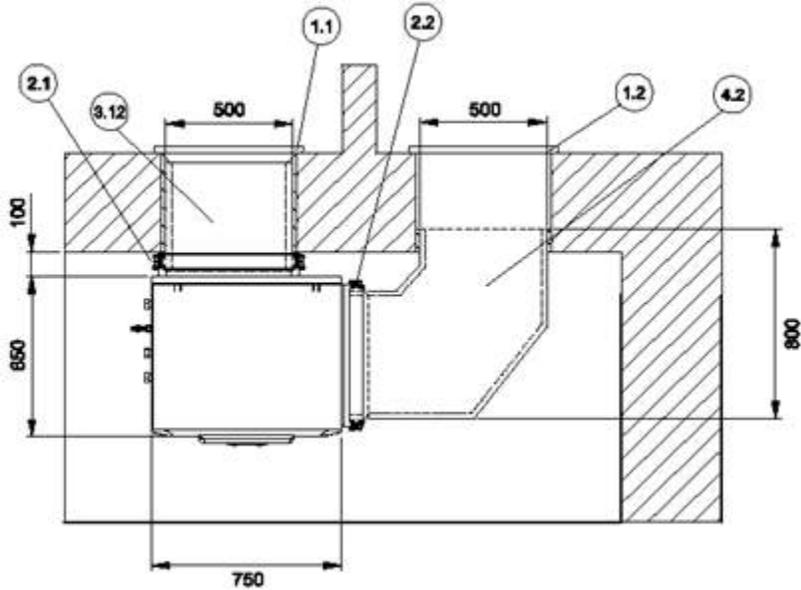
Vista dall'alto - LIK 8TES (Installazione a parete - canale aria, lato mandata)
